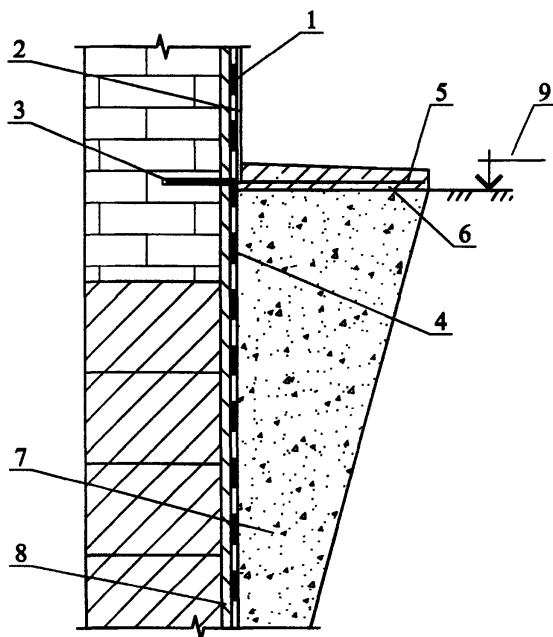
Устройство отмостки здания и гидроизоляция цоколя
